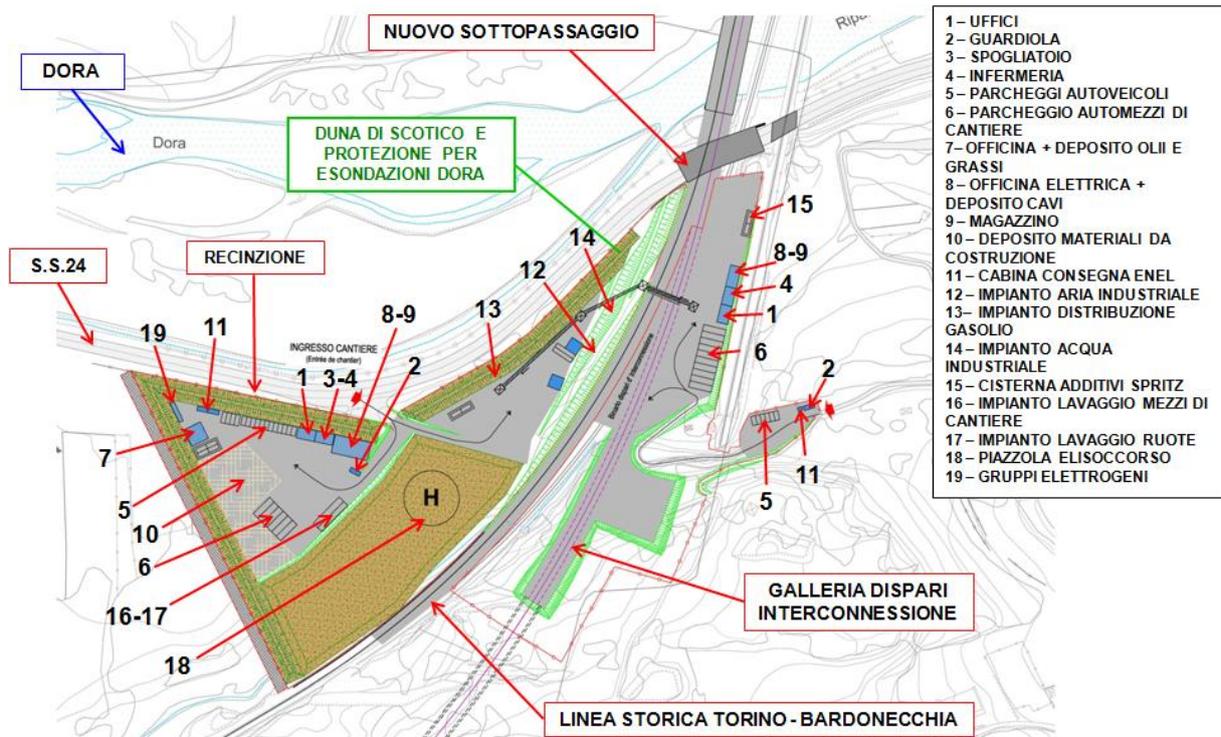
Layout Imbocco Est Tunnel di Interconnessione
